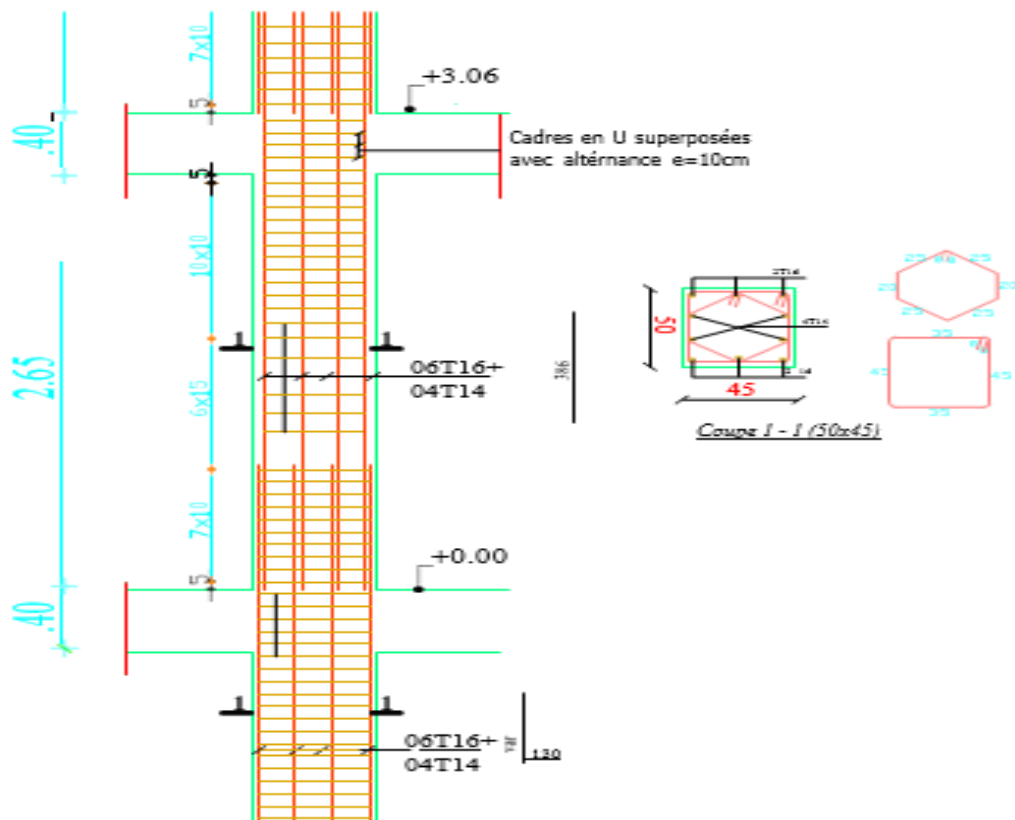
ferrailage de poteaux (RDC, 1^{er}, 2^{ème}).
